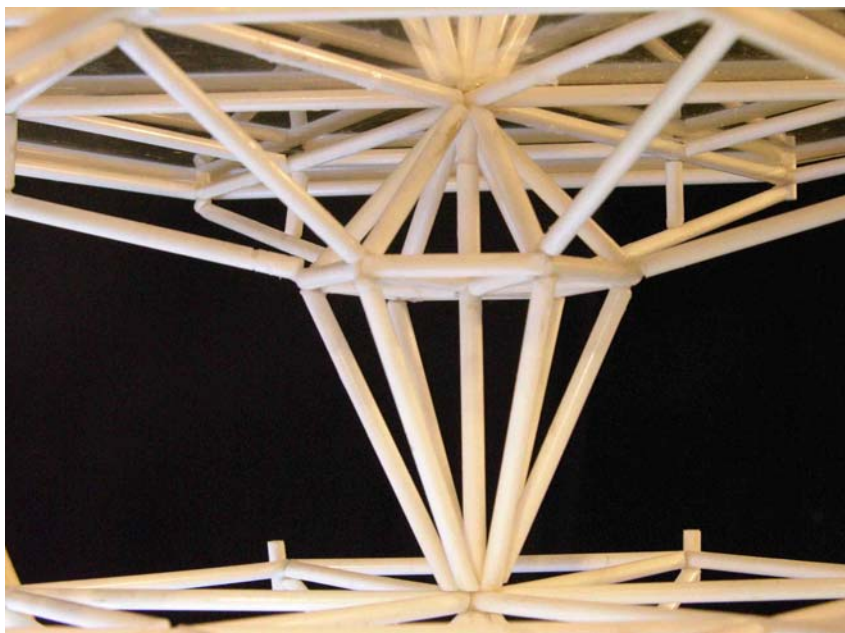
“Diamante” da maquete na escala 1:50 – execução do próprio autor
